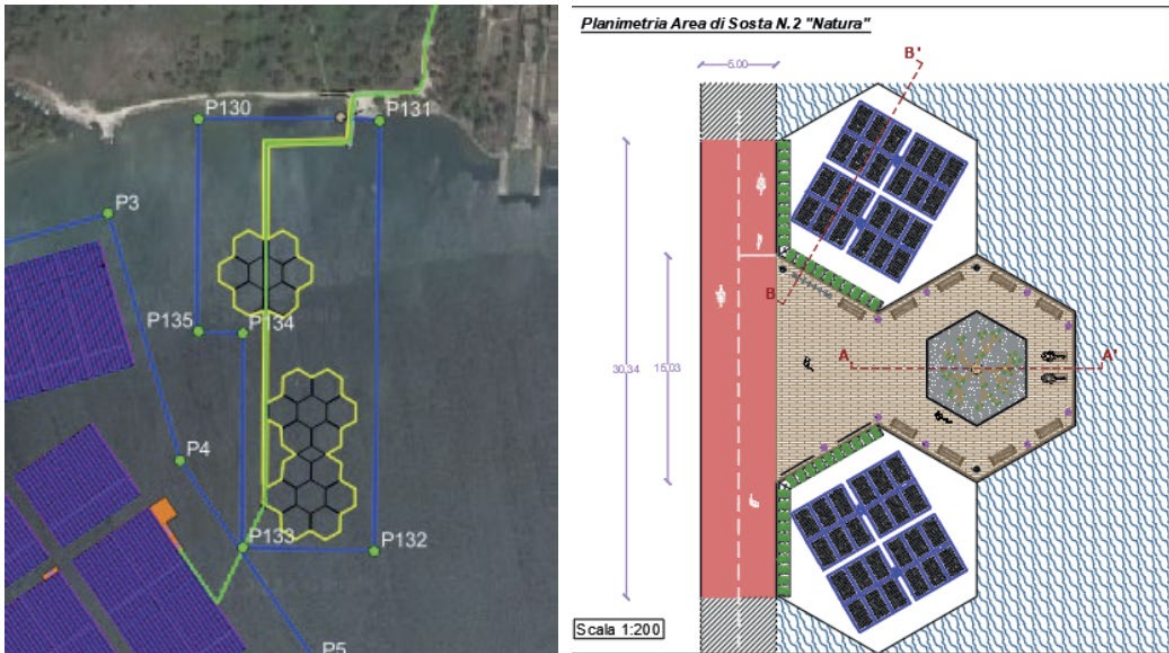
Dettaglio planimetrico delle piattaforme galleggianti ad uso turistico.
